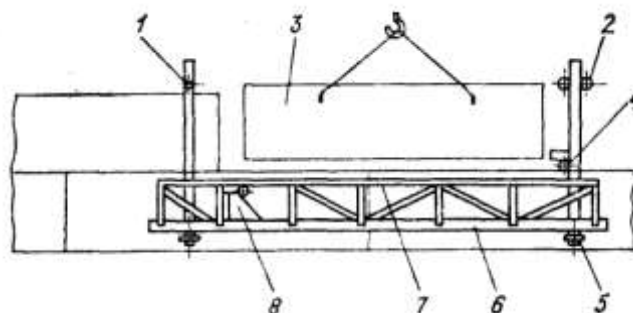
Навесные подмости для монтажной сварки вертикальной стенки резервуара
